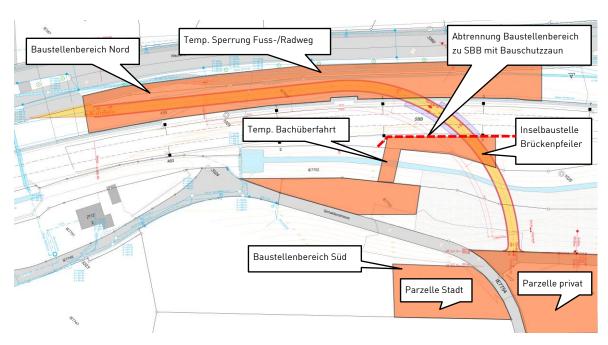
Installations- und Baulogistikflächen / Baustellenbereiche
